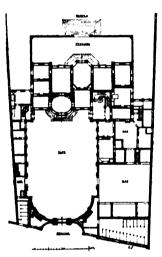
Hôtel de Matignon zu Paris. Grundriss des Erdgeschosses.
